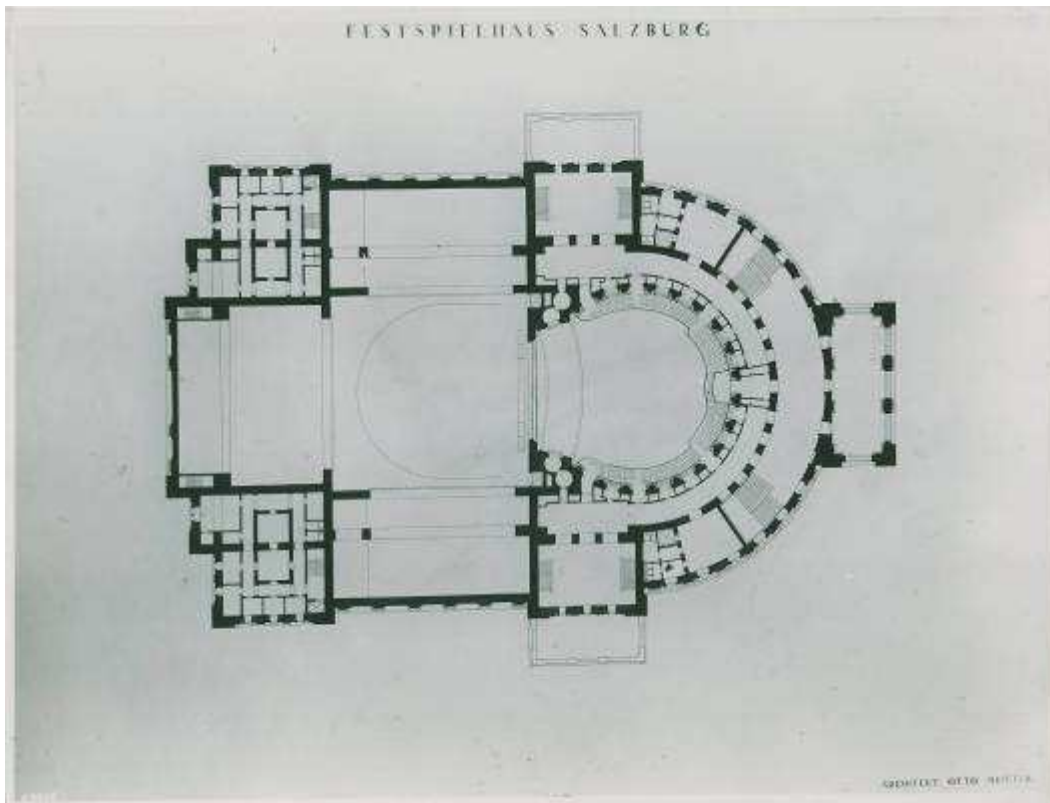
Otto Reitter, Grundriss, 2. Obergeschoss, Festspielhaus, Salzburg, undatiert (Sammlung Ostheim).
